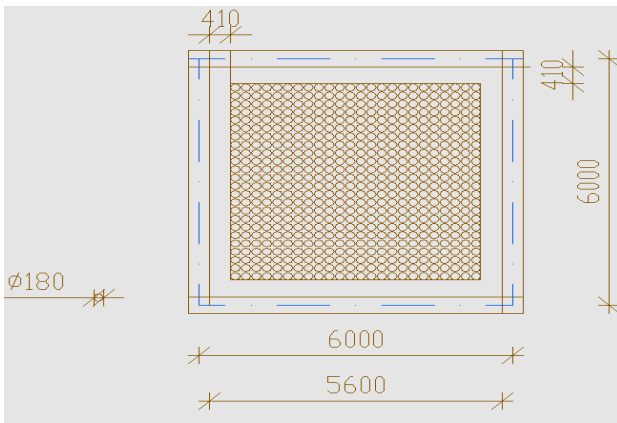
Конструктивна схема плити перекриття з пустотами з пластиковими кулями:
